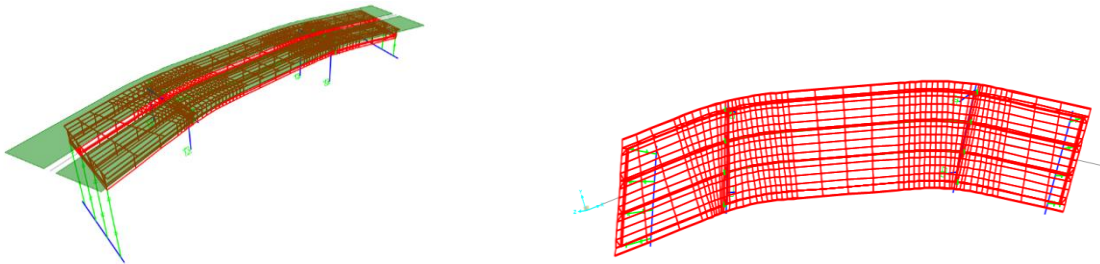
Vista del modelo en 3D y vista en planta para el puente río Kooper. Fuente: Elaboración propia, 2017.
